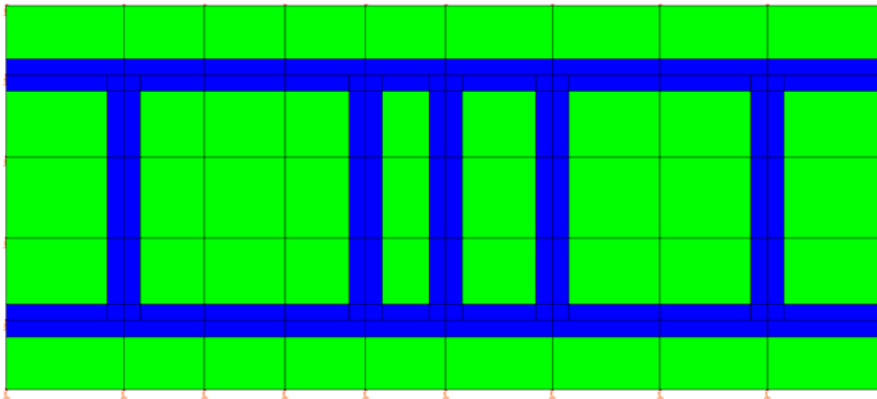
Vista in Pianta Platea e Travi di Fondazione
